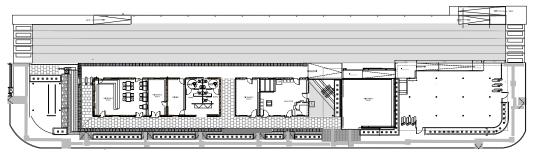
Plano definitivo diferenciando los tres sistemas constructivos
